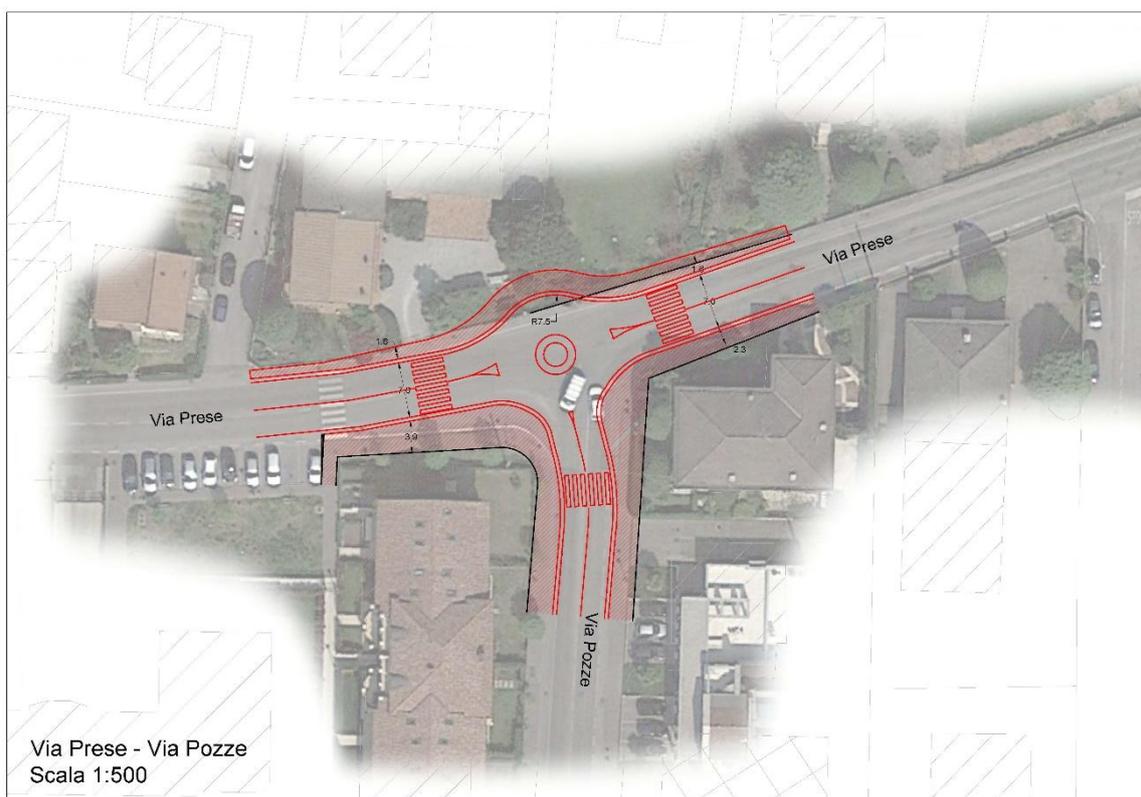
Particolare dell'intersezione via Prese - via Pozze
